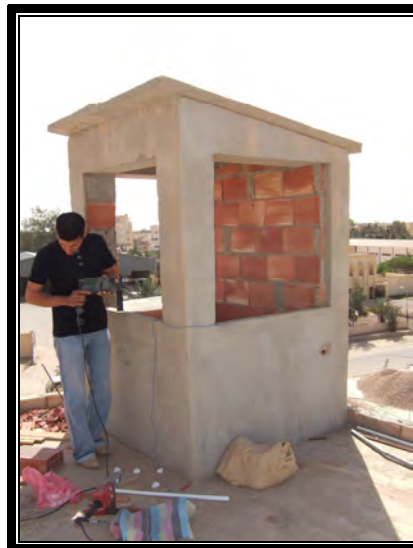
Pose des dalles préfabriquées et finalisation des travaux de maçonnerie
